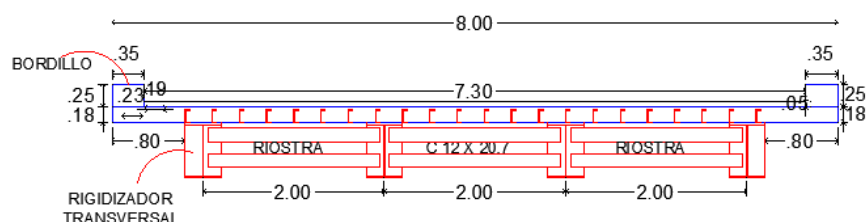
Sección transversal de la estructura de un puente en concreto postensado de 12 metros. (ver anexo 03 página 02)
